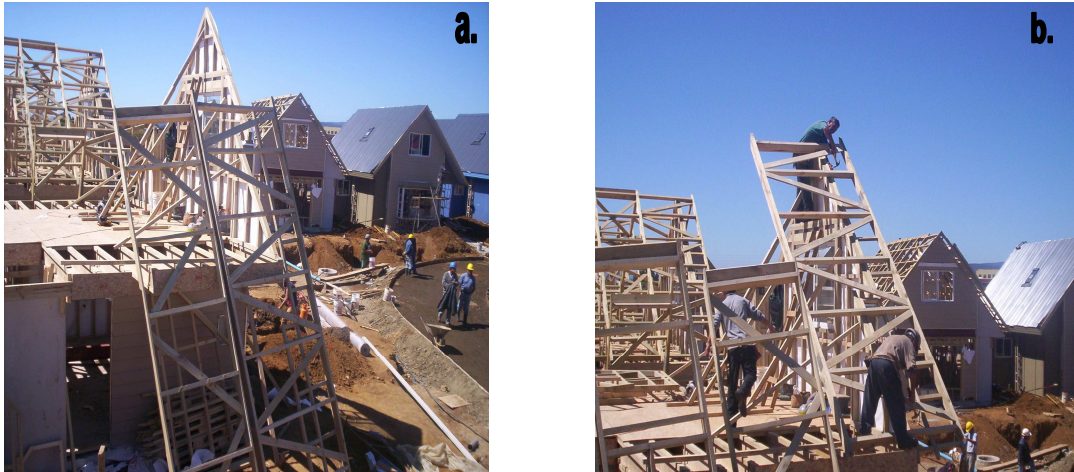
a. Ubicación de la estructura de techumbre para su posterior elevación y montaje
